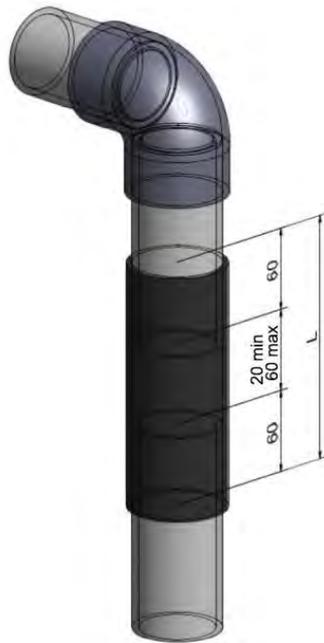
Positionnement correct du tube de raccordement flexible (noir) ; dimensions en mm
